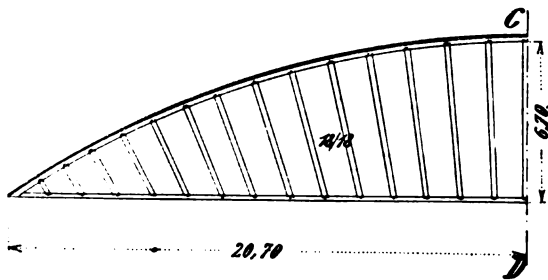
Lehrgerüst der Monierbrücke über die kleine Tulln bei Zöfing.
